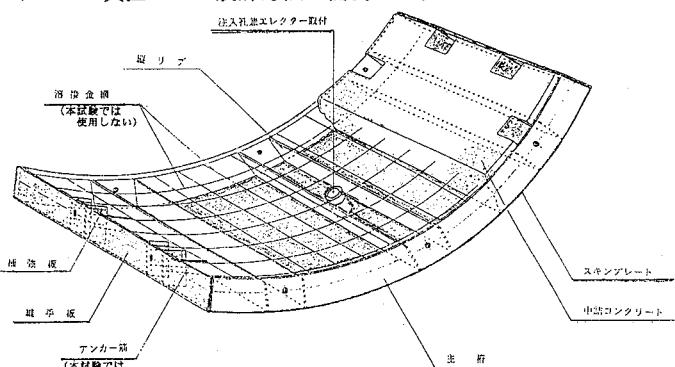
コンクリート中詰め鋼製セグメント鳥かん図
